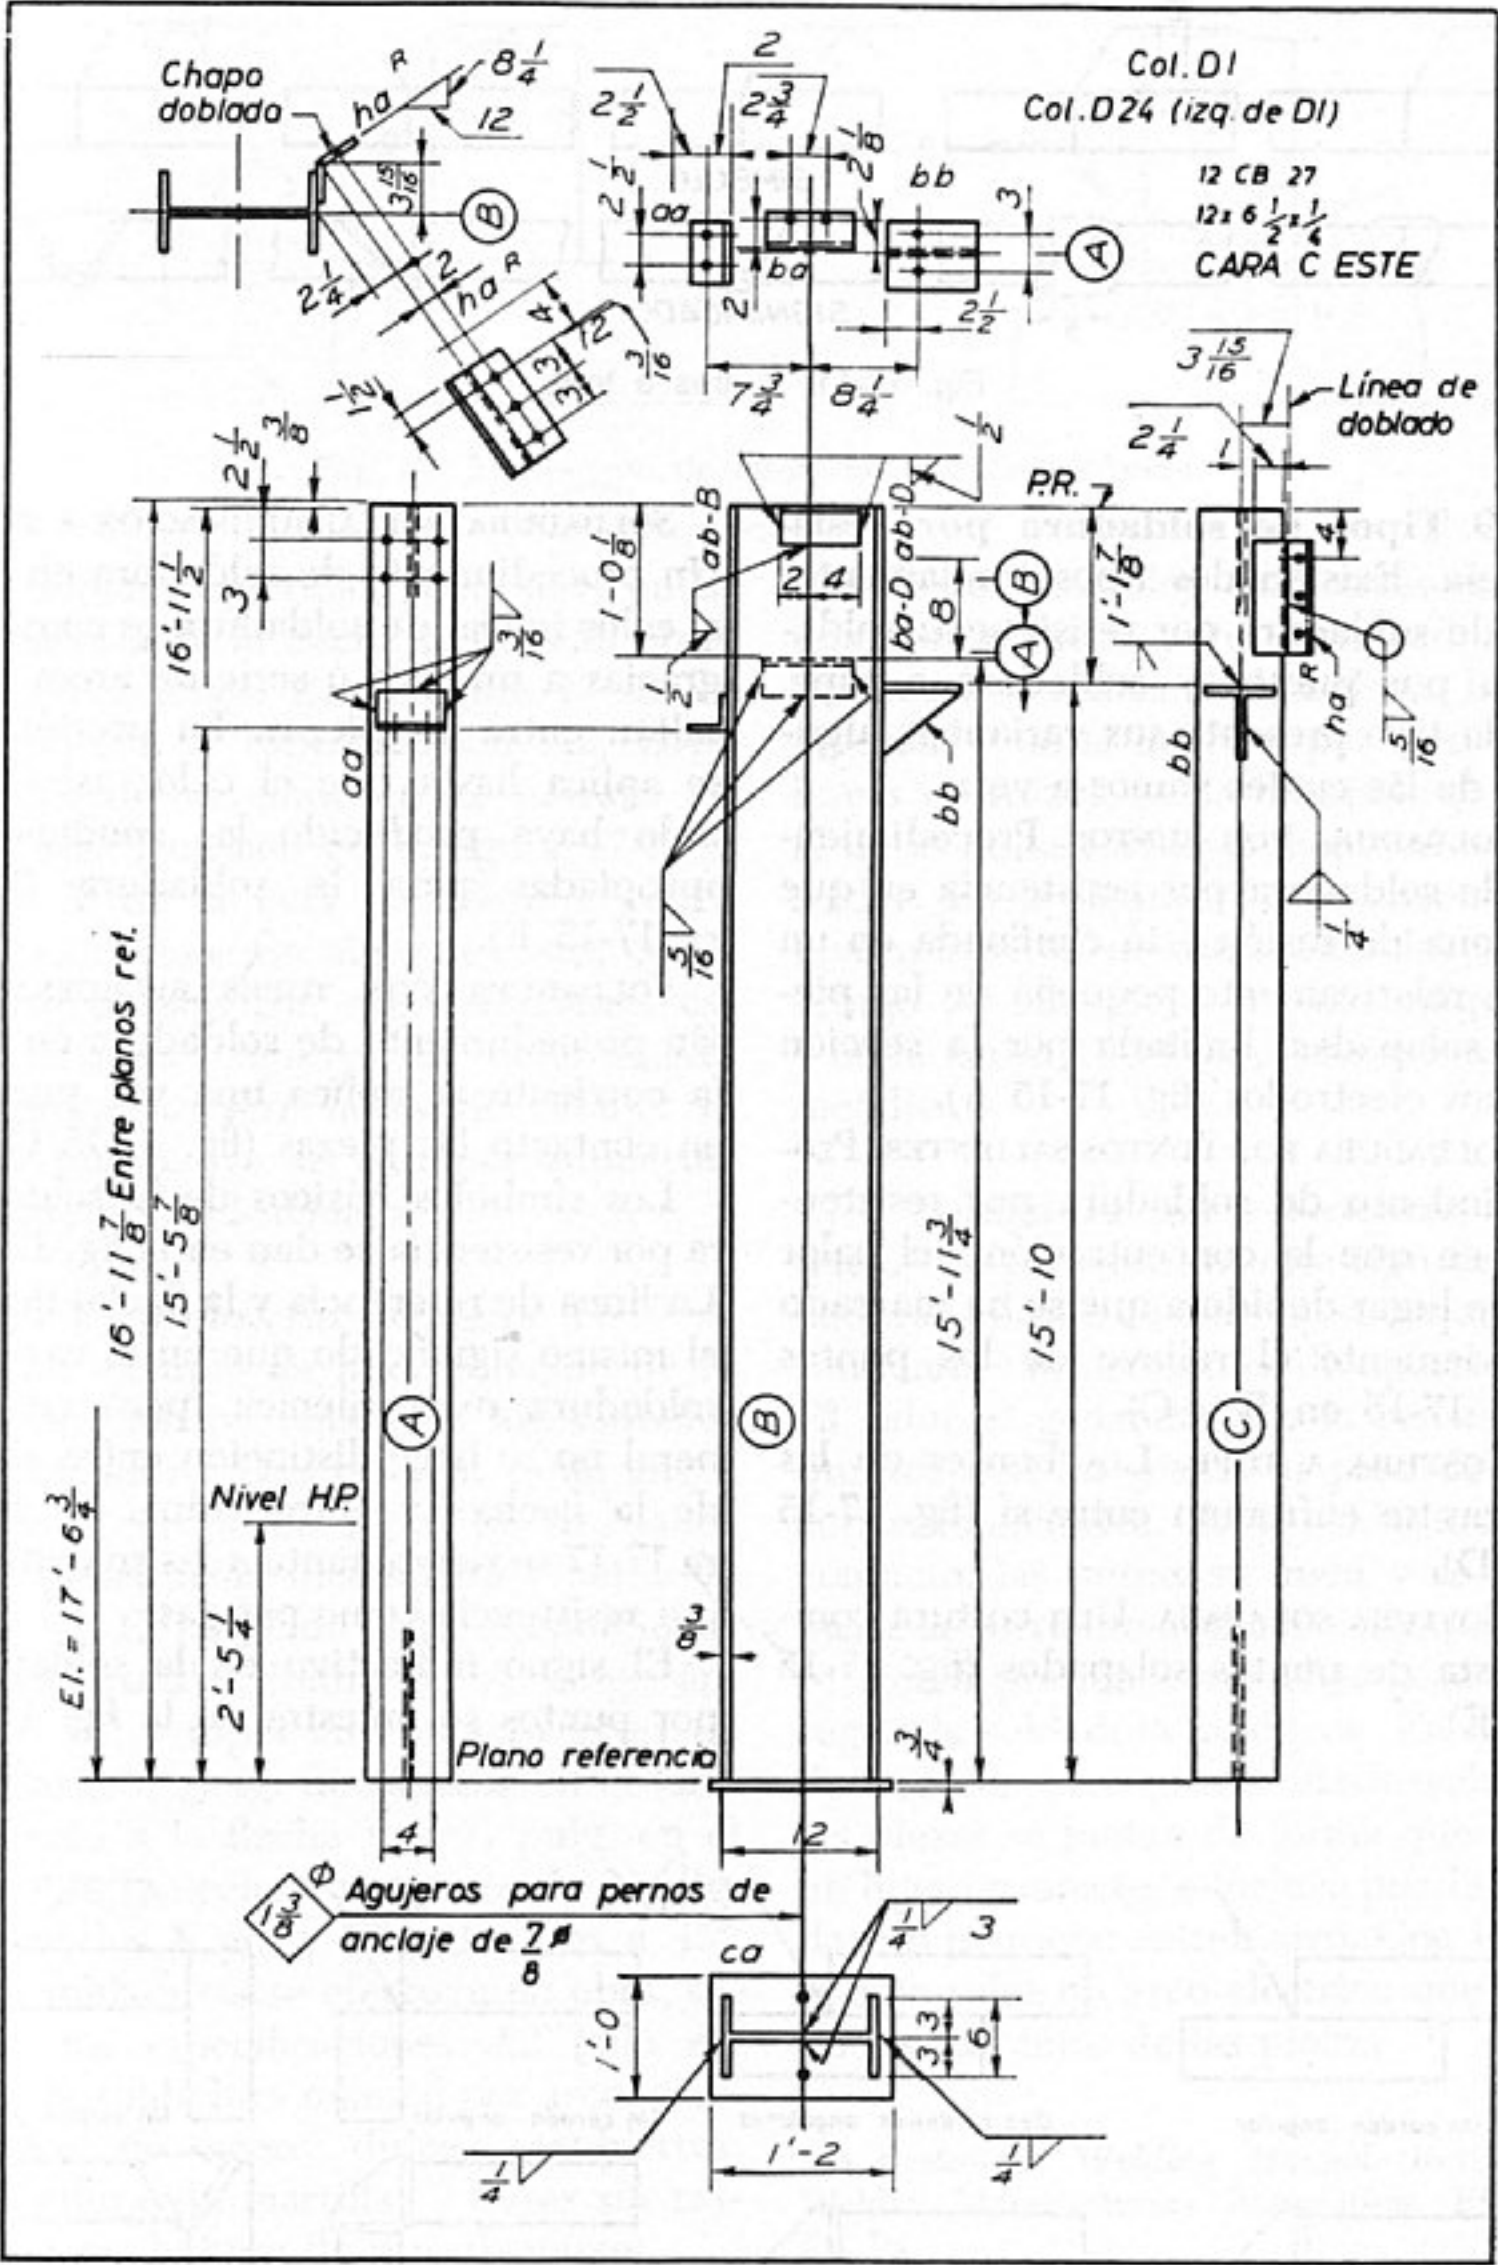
Símbolos de soldadura aplicados al dibujo de una estructura. (American Bridge Company.) Prob. Q*12.
